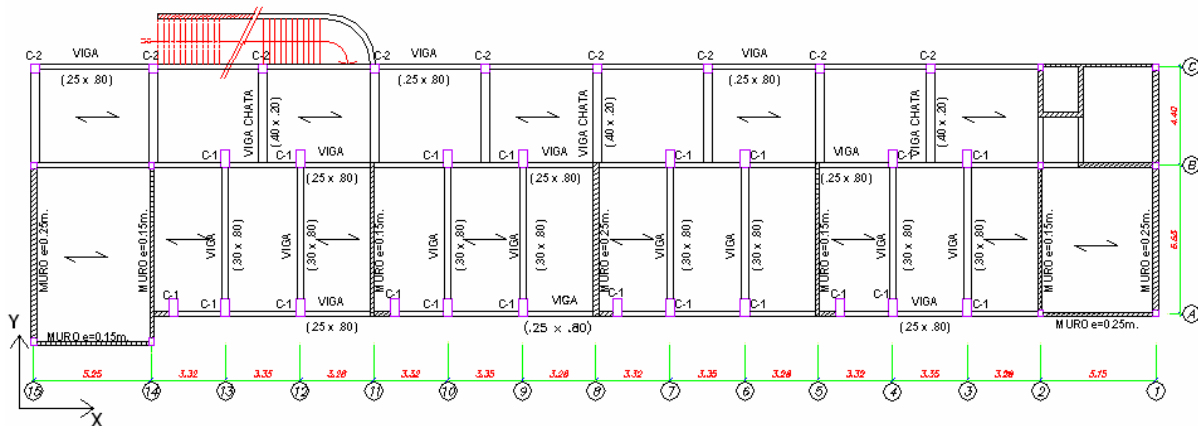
Planta del sistema estructural del Edificio Gran Unidad Escolar
